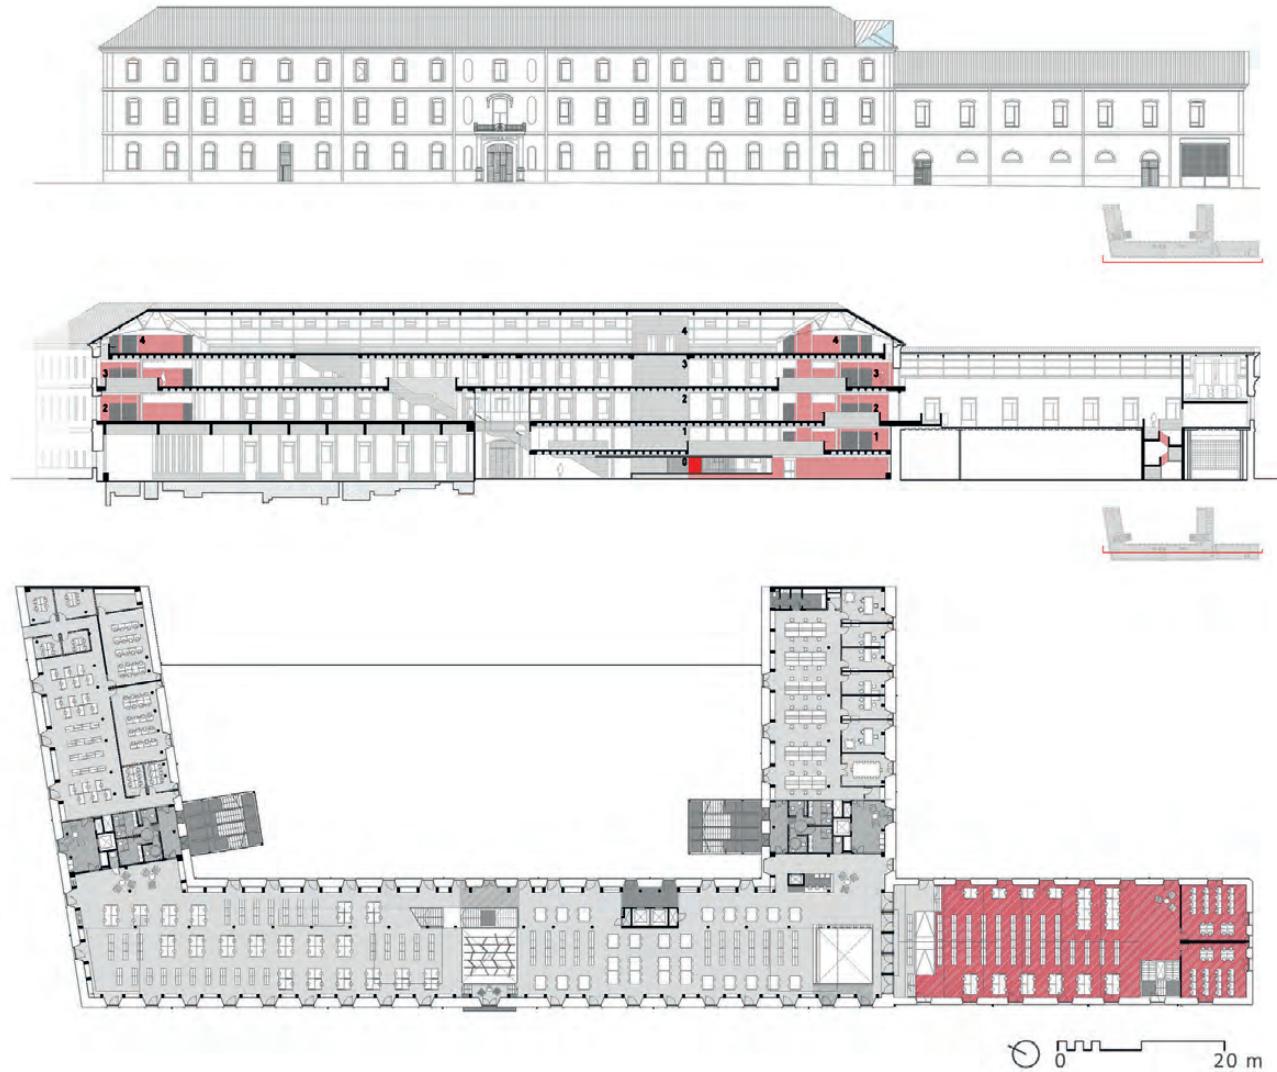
Planta, alzado y sección longitudinal del CRAI. CDE Arquitectura / Figure 5. LCR plans, section and elevation. CDE Arquitectura.
